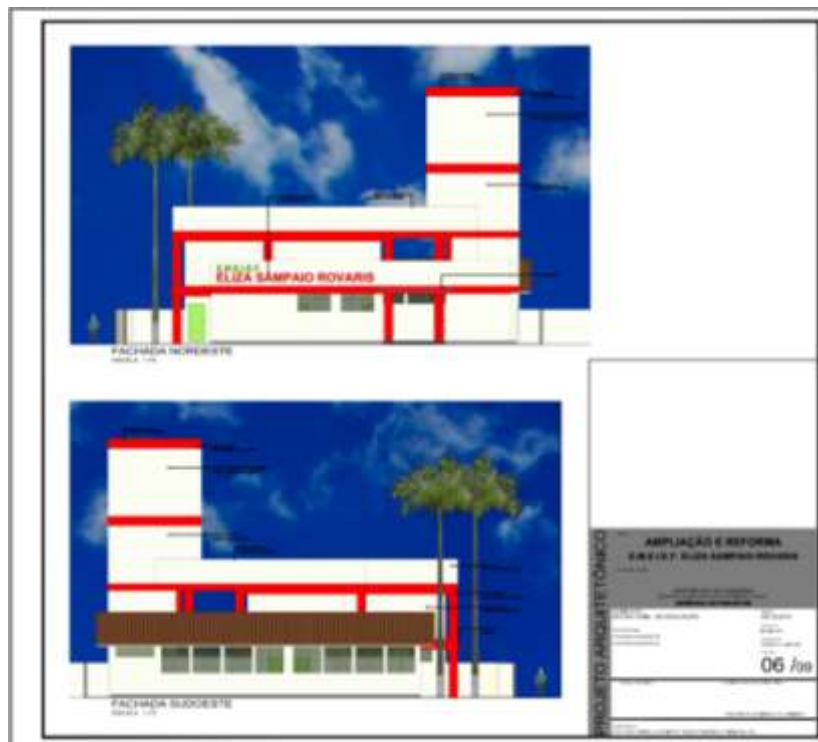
Fachada frontal do prédio. (Fonte: PMC)
